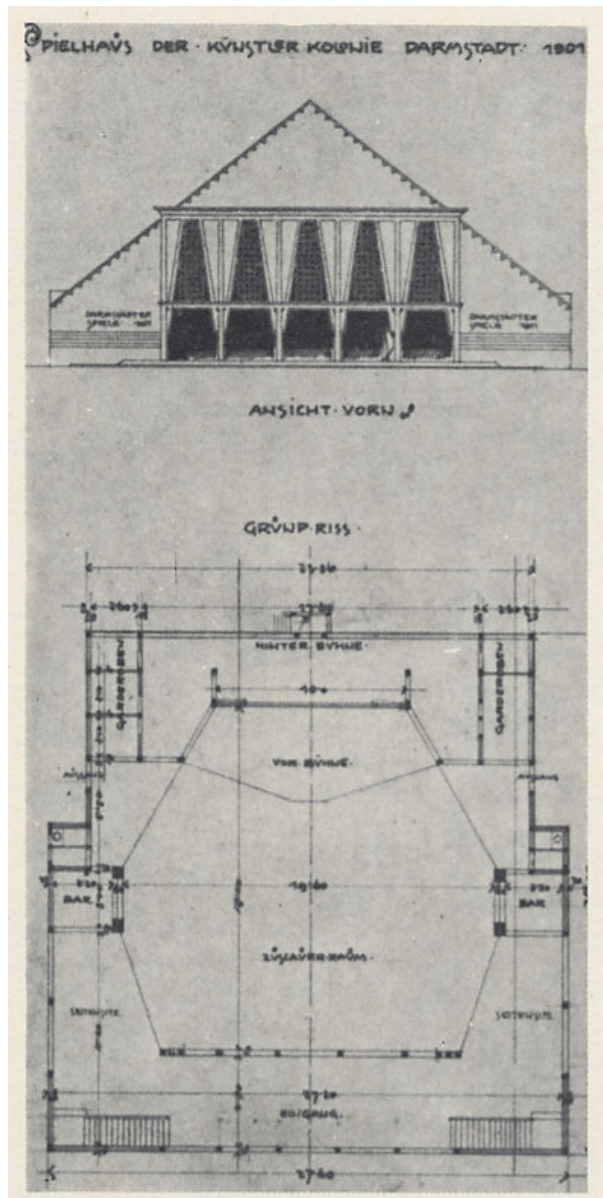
Pianta dello Spielhaus e studio di scena, di J. M. Olbrich.
